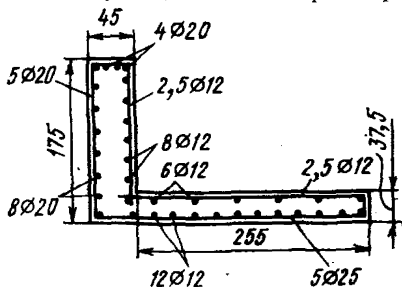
Расчетное железобетонное сечение открьлка надстройки
